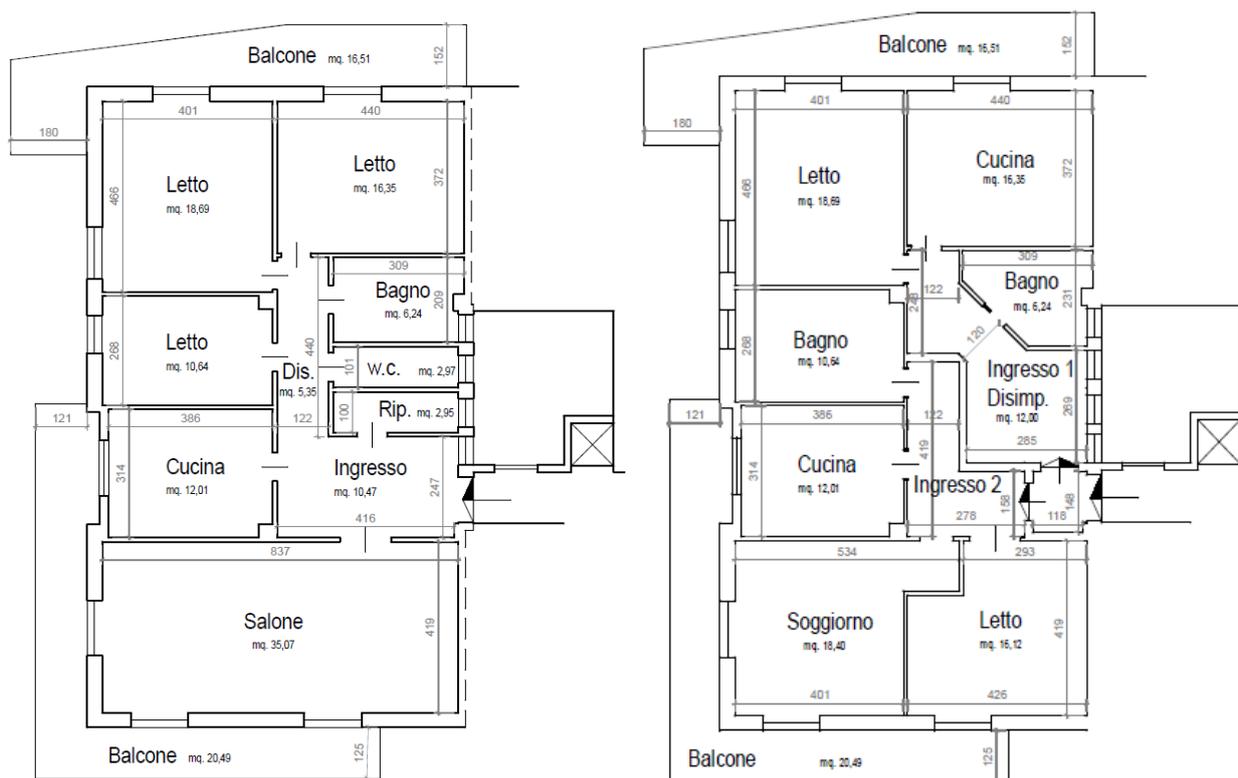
Planimetria attuale ed ipotesi di possibile frazionamento in due unità immobiliari.
